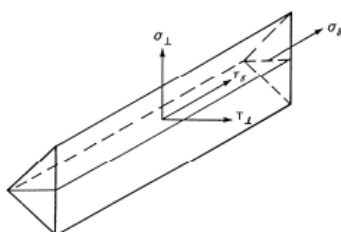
Tensões no plano crítico do cordão de soldadura (NP EN 1993-1-8, 2010)
